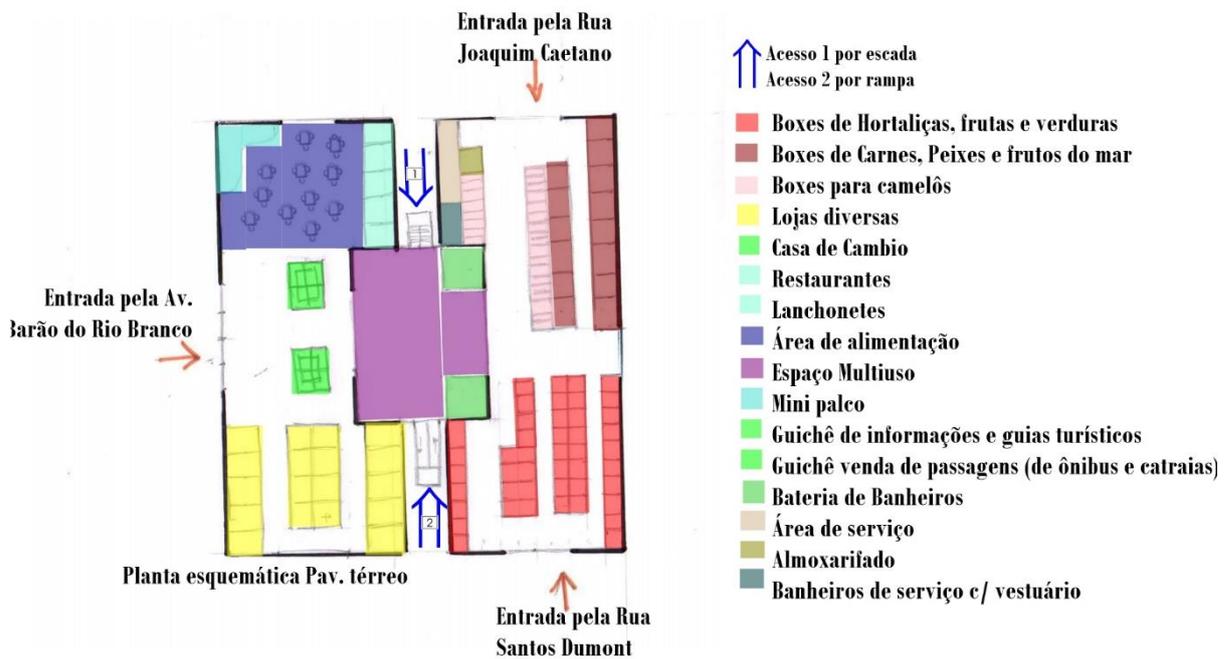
Planta baixa Esquemática. Fonte: autora, 2016.
